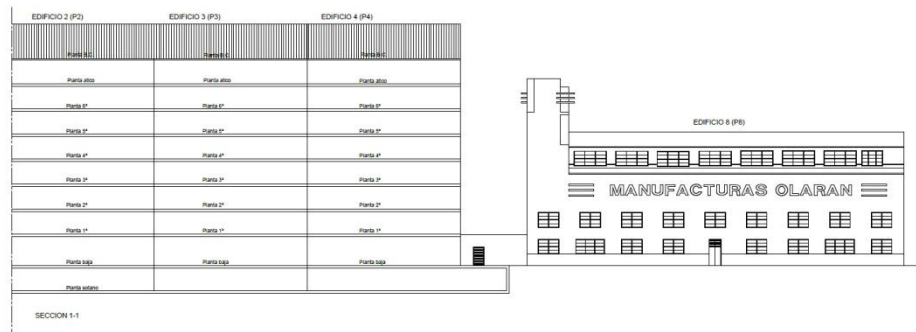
Planimetría de la ordenación para el ámbito U.E.4.1.
